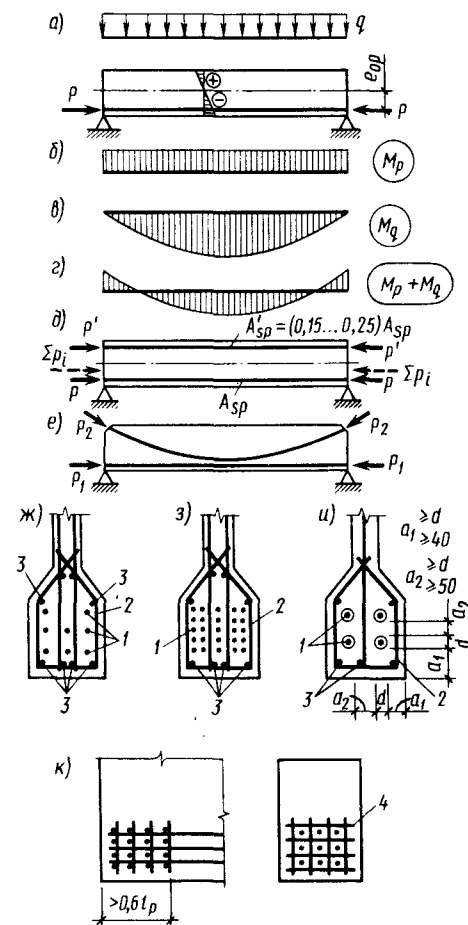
Схемы армирования балок предварительно напряженной арматурой (а...е); размещение напрягаемой арматуры в растянутой зоне балок (ж...и); усиление торца элемента косвенным армированием (к): 1 — напрягаемая арматура; 2 — хомуты; 3 — ненапрягаемая продольная арматура; 4 — сетки косвенного армирования
